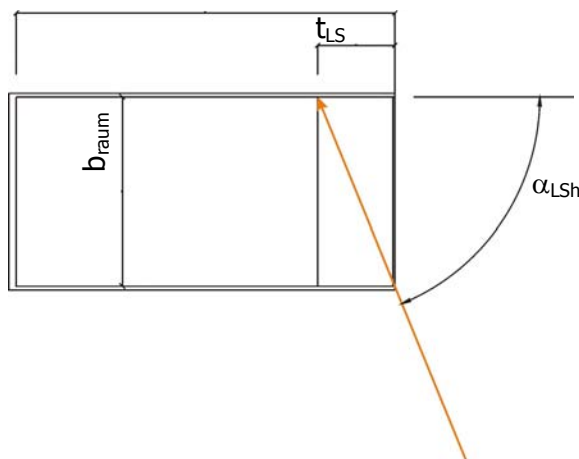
Grundriss des Modellraums mit internem Lichtschwert
